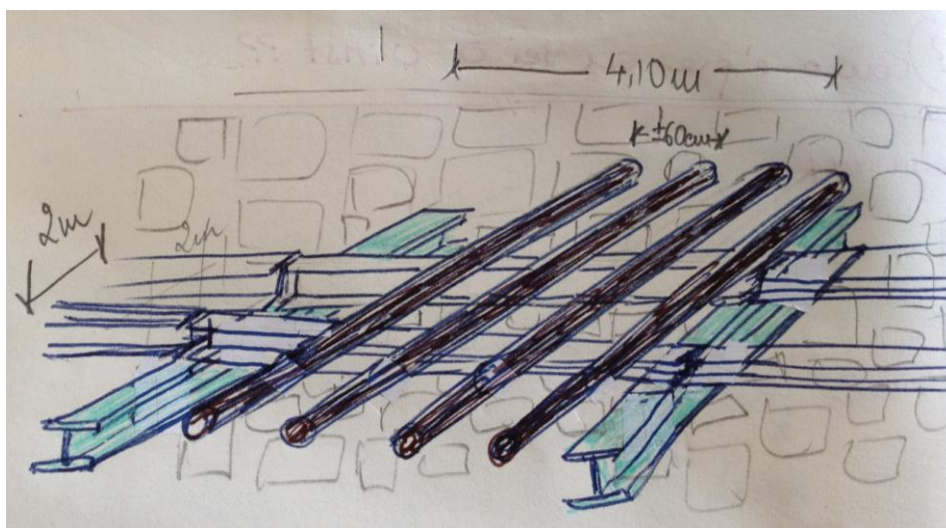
Esquema de funcionamento estrutural do pavimento do piso 0
